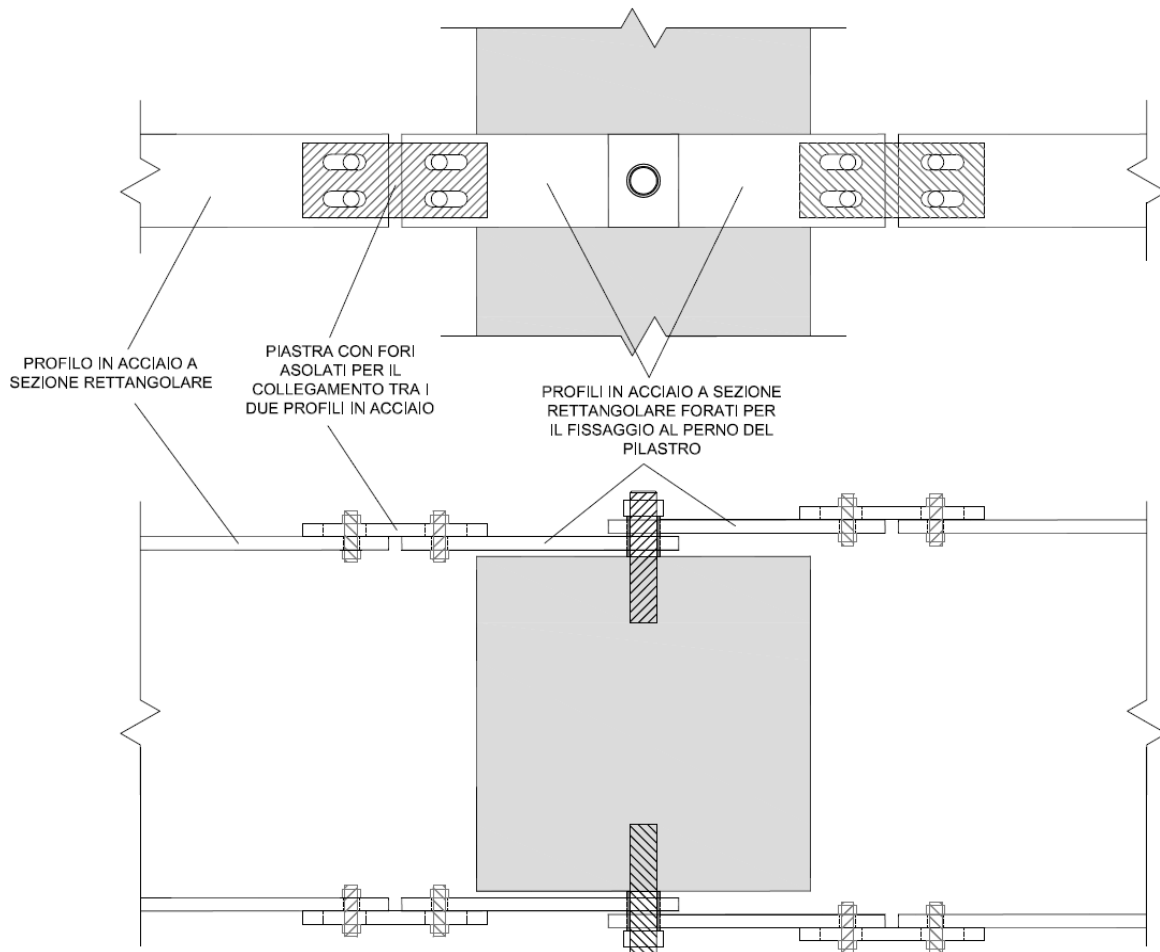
Collegamento dei pilastri tramite piatte metalliche alle estremità del pilastro
